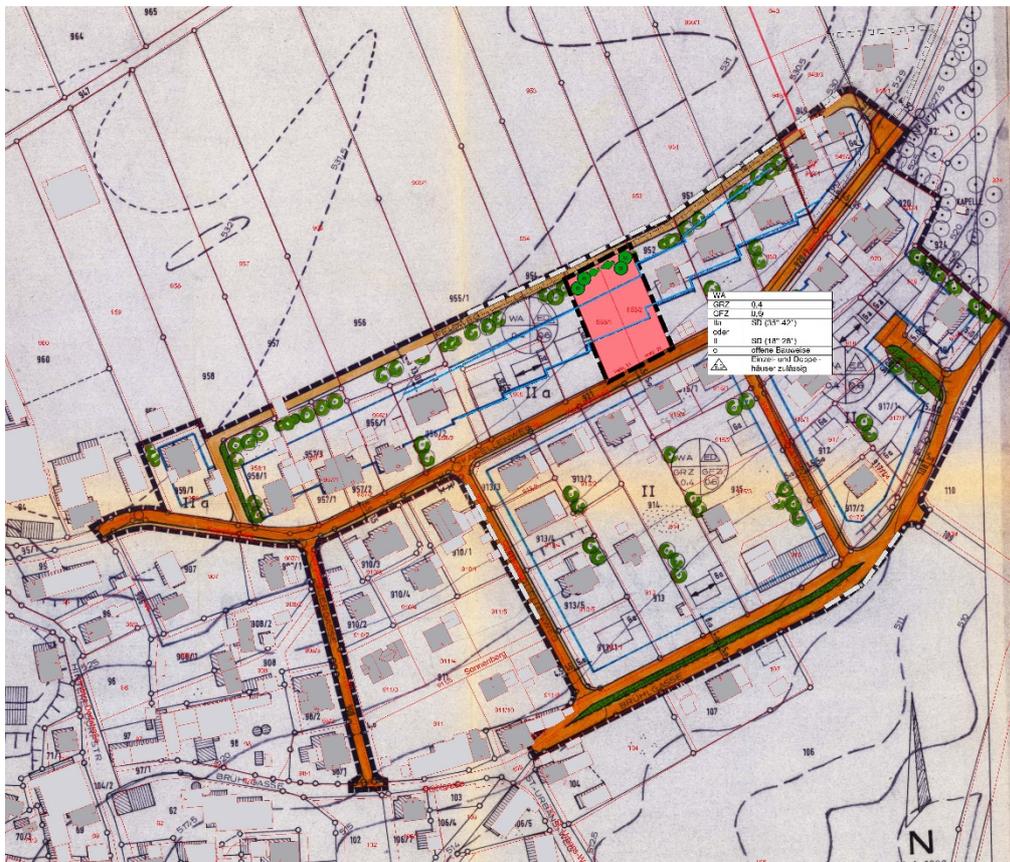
BP 'An der Brühlgasse' mit Darstellung Änderungsbereich
